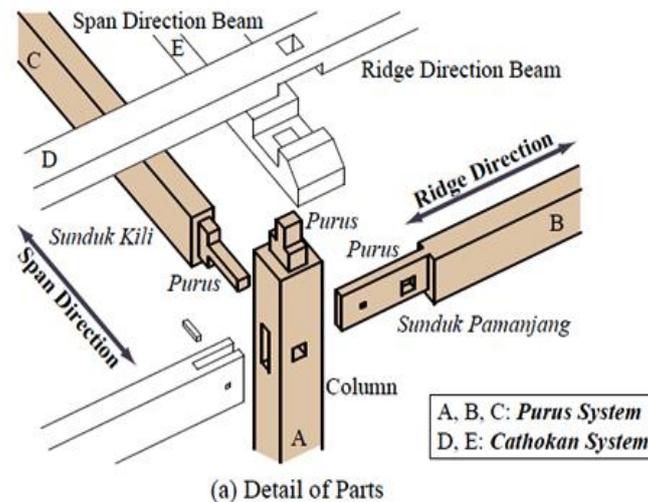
Traditionelle Steckverbindungen im javanischen Hausbau
